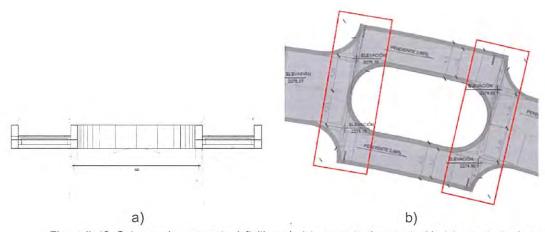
Columna de propuesta definitiva: a) vista en corte de cruceta, b) vista en planta de crucetas. Fuente: Planos de proyecto, 2021.
